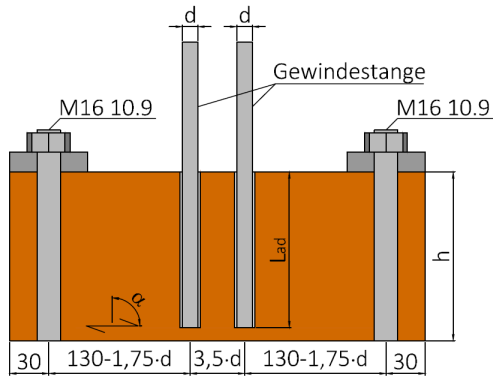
Abmessungen der Prüfkörper mit zwei Gewindestangen, alle Maße in mm.
